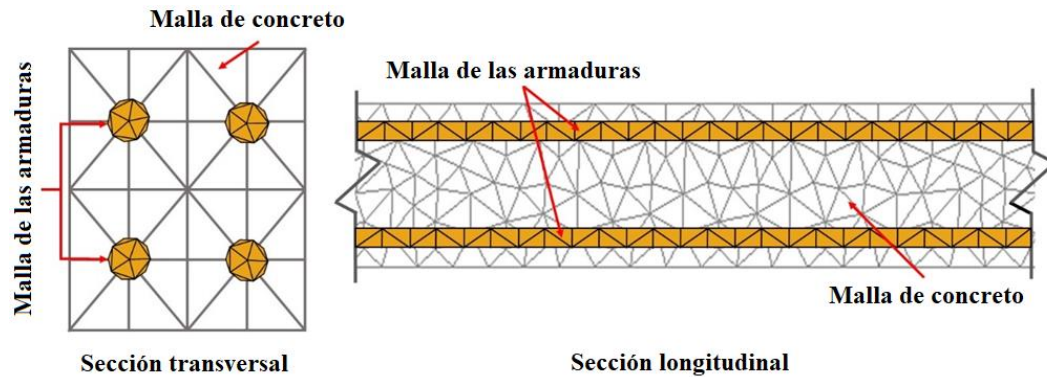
Discretización de la sección transversal y longitudinal de una viga de concreto.
